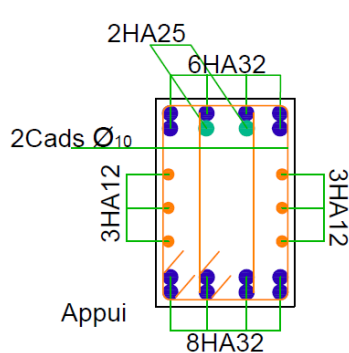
Schéma de ferrailage (section transversale) en appui
